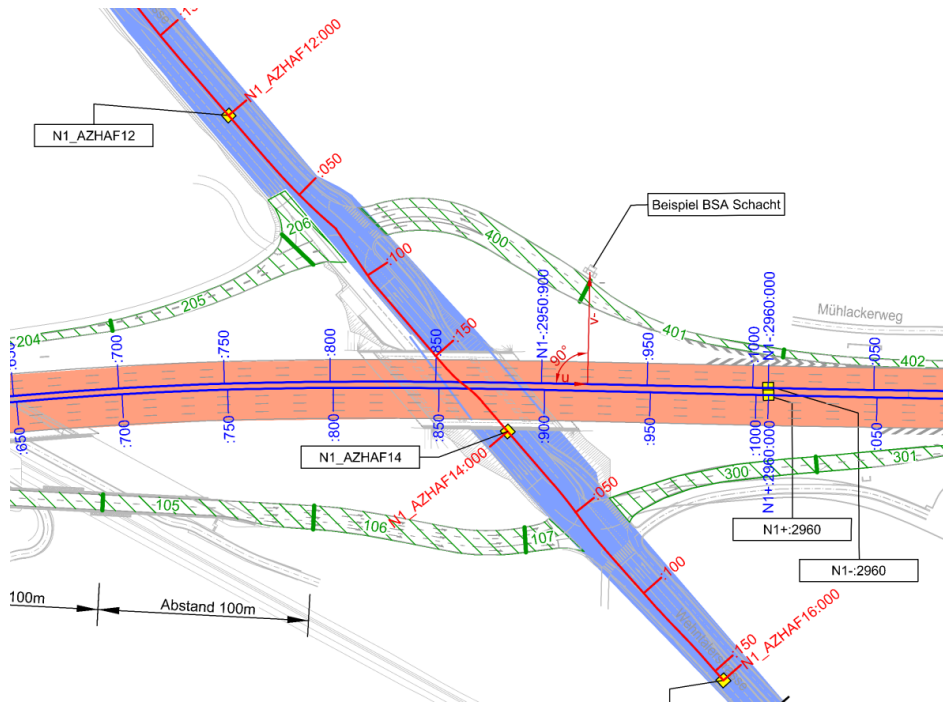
Extrait d'un plan avec utilisation du SRB.
